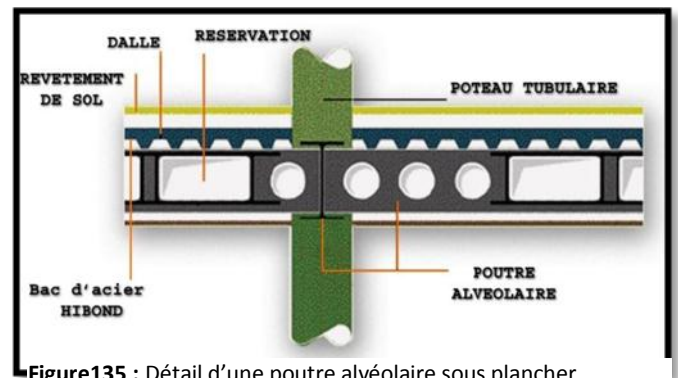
Détail d'une poutre alvéolaire sous plancher collaborant. Source : www.constructalia.com
